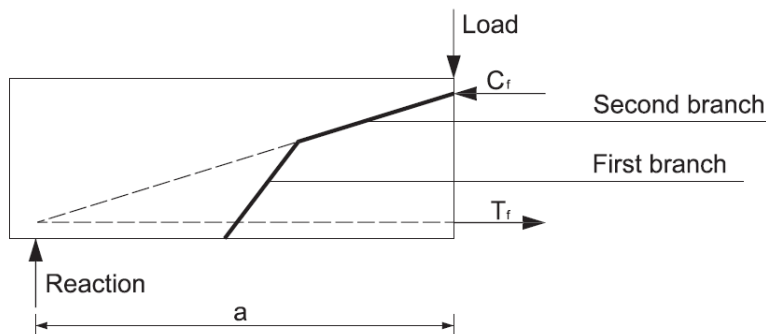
b Formación de la fisura crítica en secciones sin armadura transversal (Zararis)
